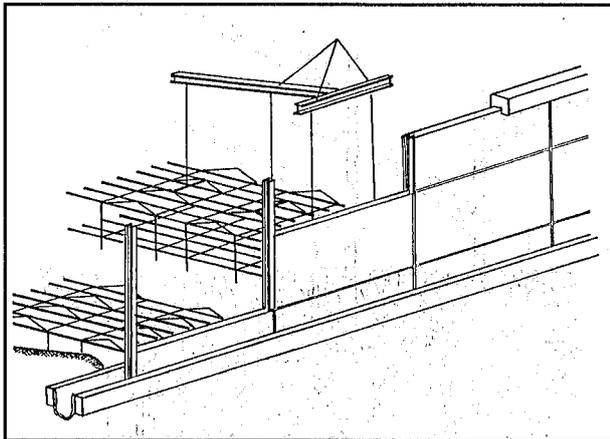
Bewehrte Erde - Schemazeichnung für Unterwasserkonstruktion [9]
